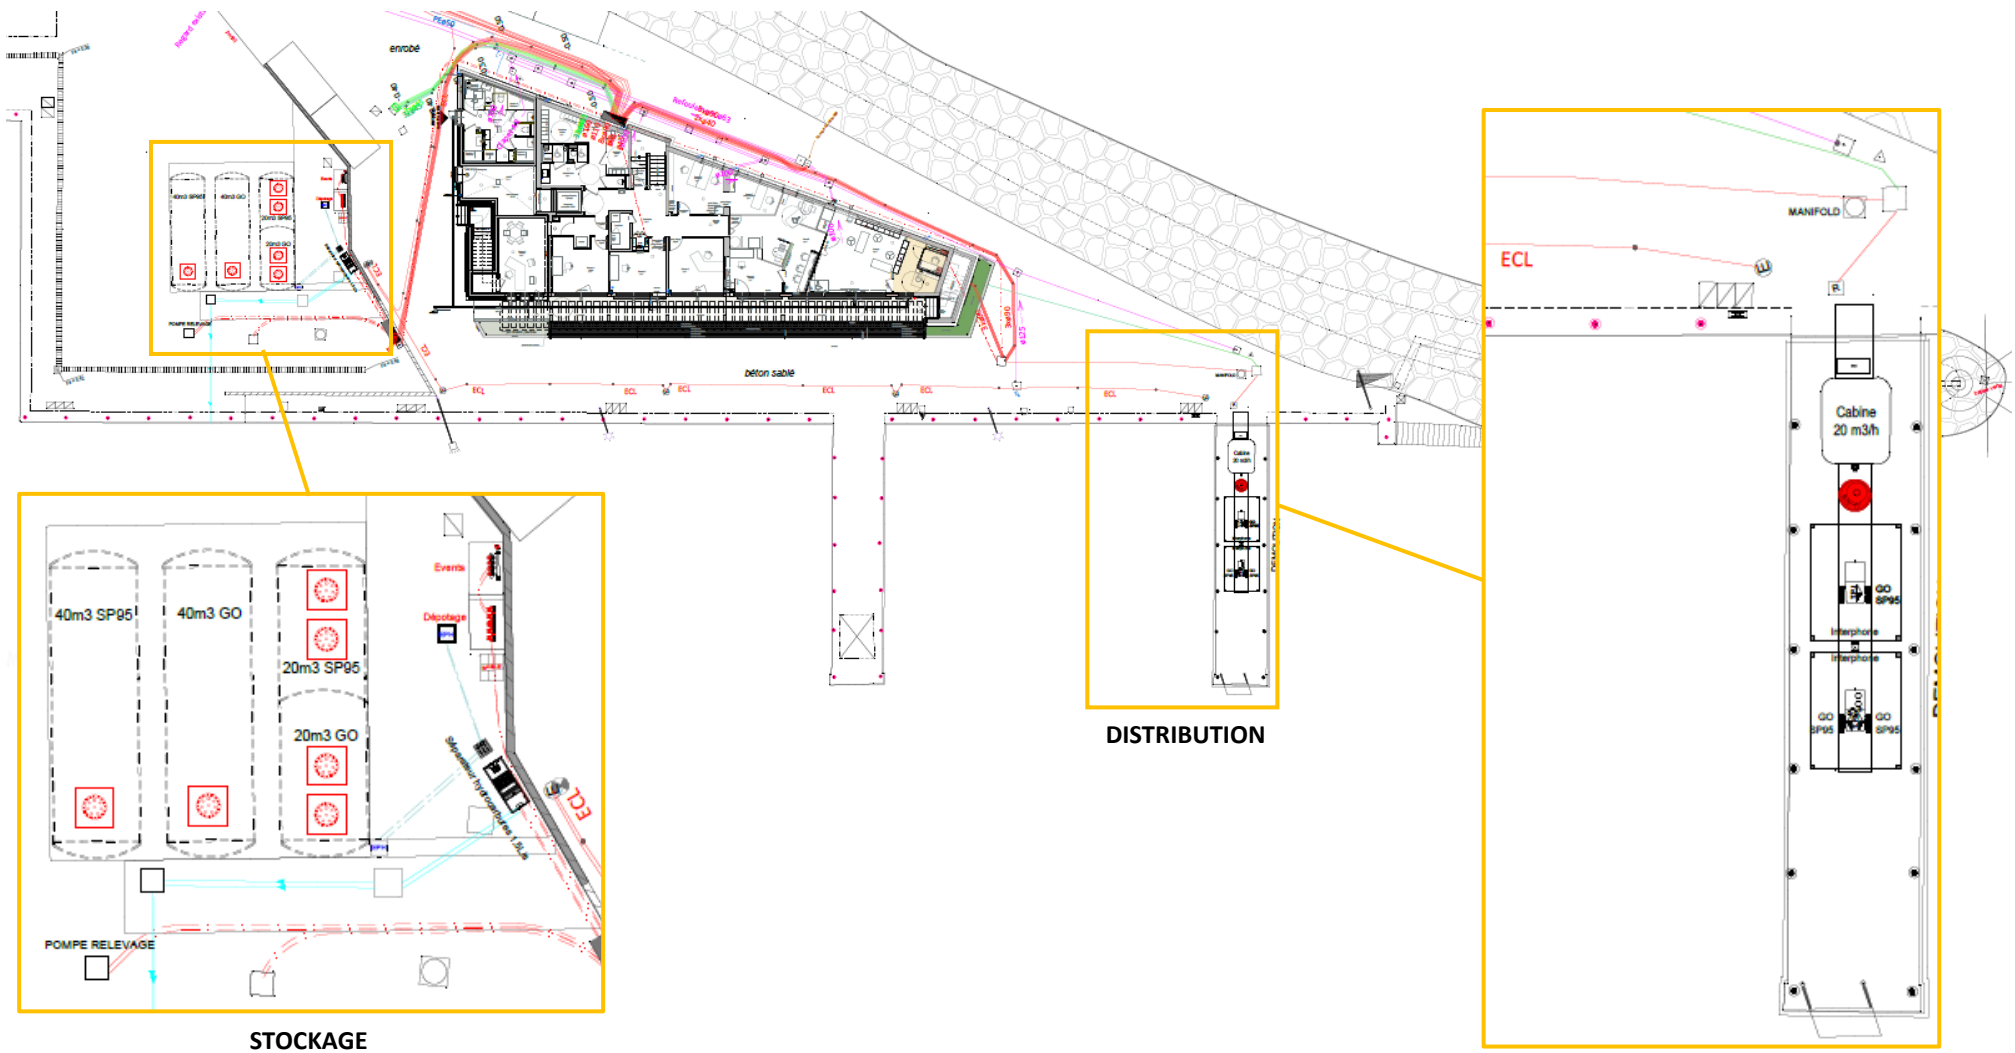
Plan de la station d'avitaillement actuelle (SUEZ/GECOS, 2023)
